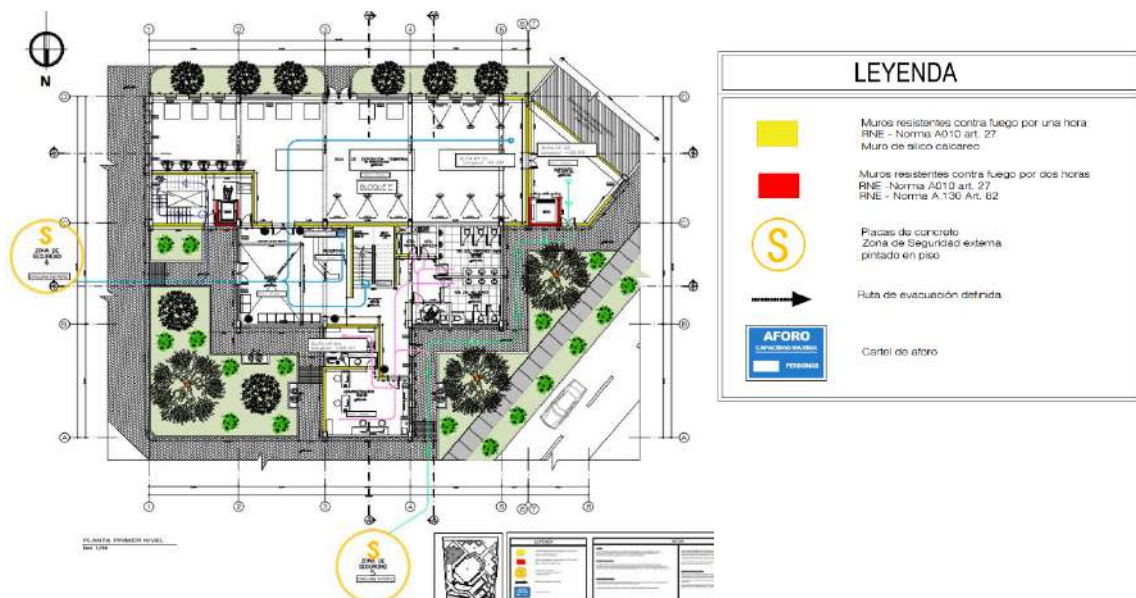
, plano de evacuación primer nivel, de acuerdo con las características constructivas se considera muros resistentes al fuego en toda la zona de evacuación, para evitar la propagación de fuego, ante un siniestro.
